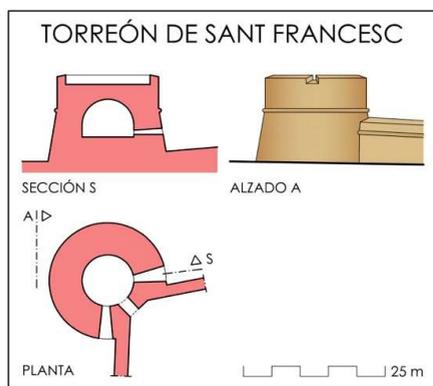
Propuesta formal de planta, sección y alzado del torreón de Sant Francesc (M. Bevià i Garcia y J. M. Giner Martínez).
